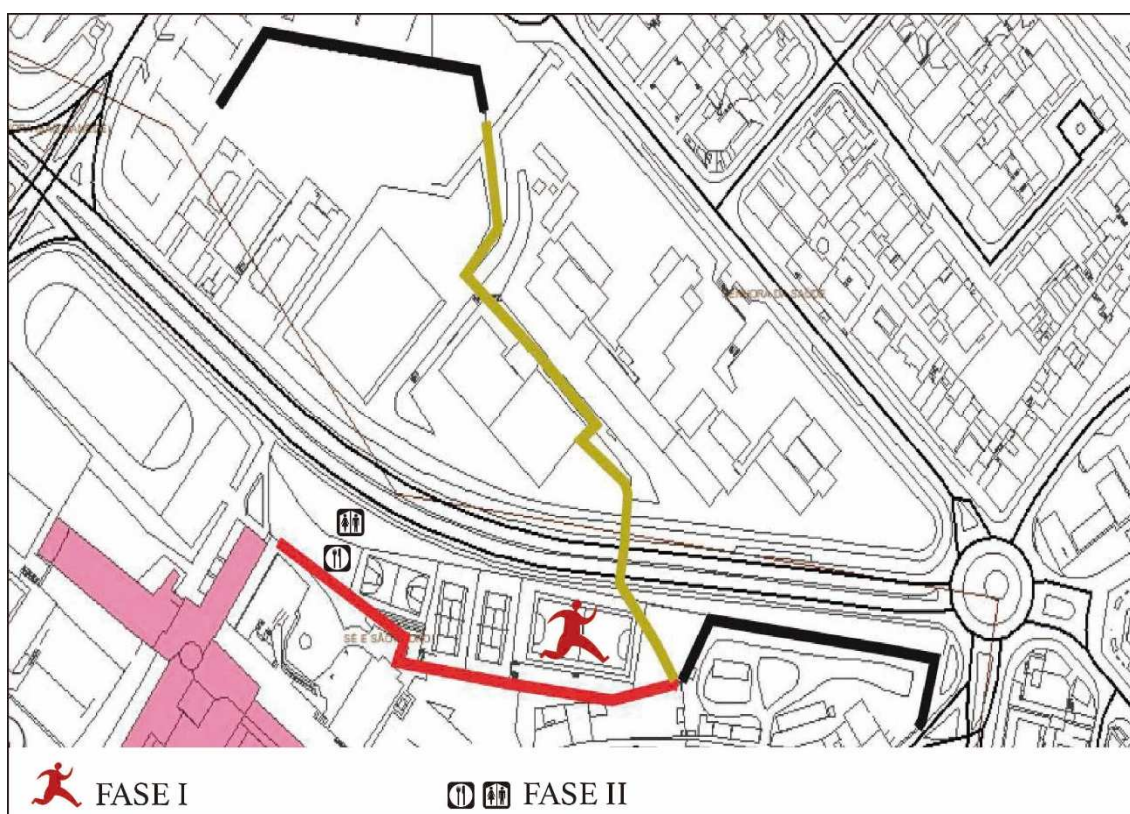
Planta de localização da obra (adaptada Maia, 2015)
